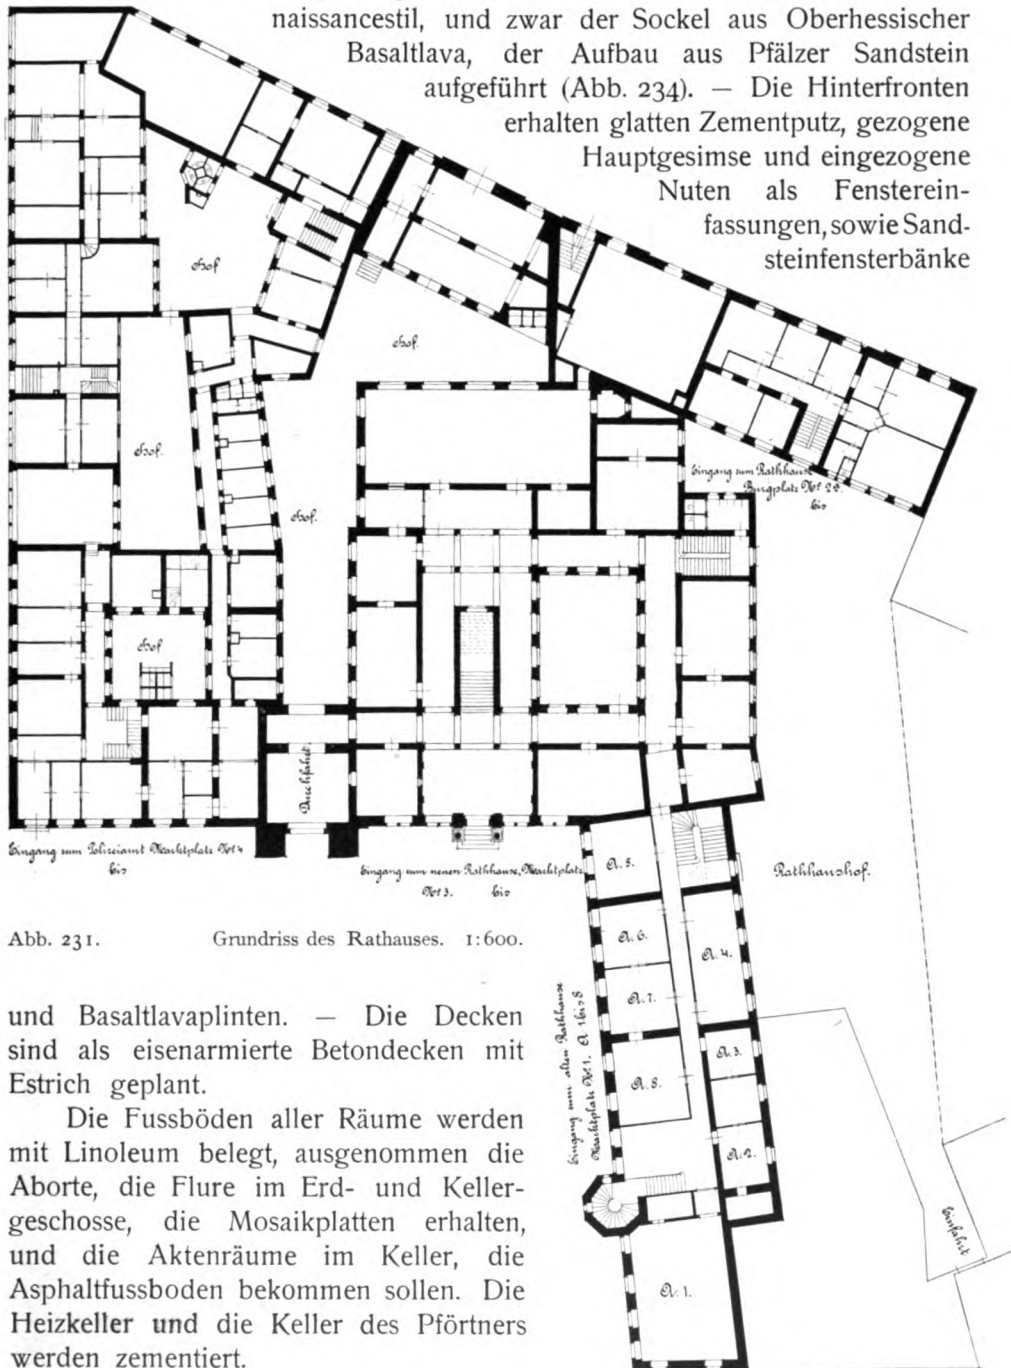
Grundriss des Rathauses. 1:600.
